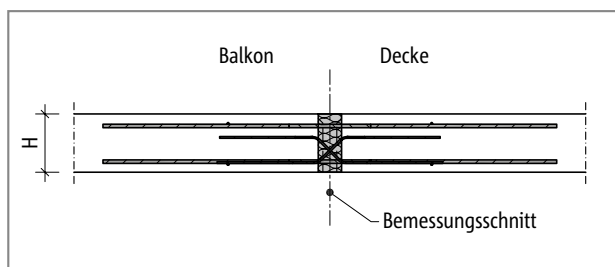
Schöck Isokorb® Typ D: Statisches System
